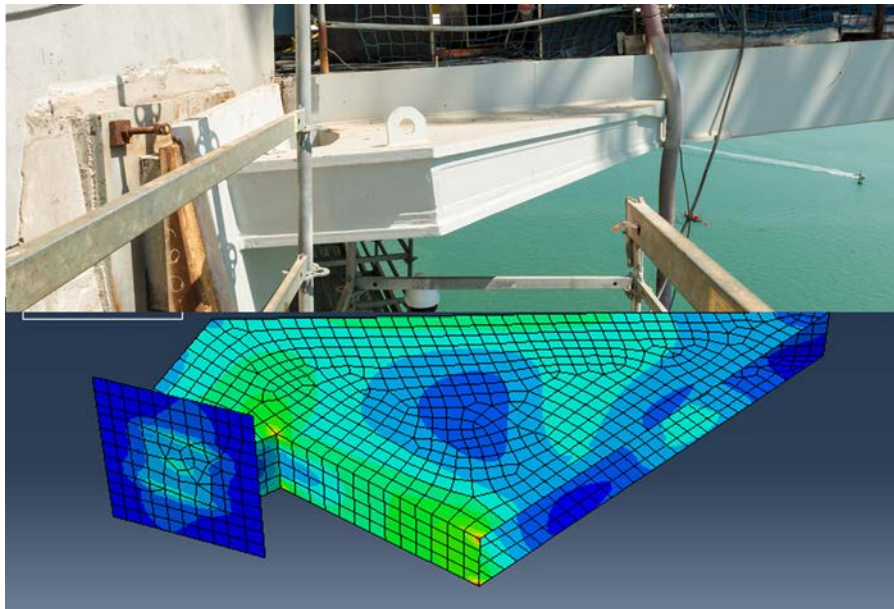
Detalle de empotramiento provisional frente a flexiones de eje vertical en las torres durante la construcción.
